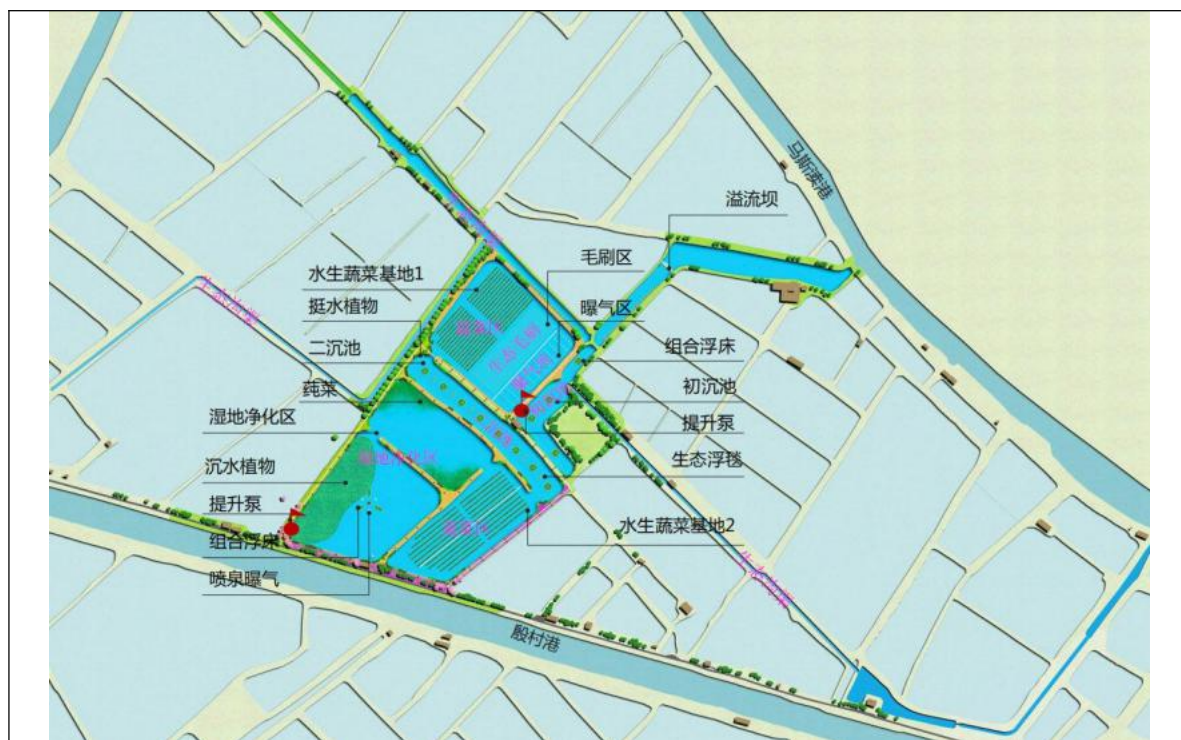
水产养殖尾水标准化治理工程平面布置示意图
